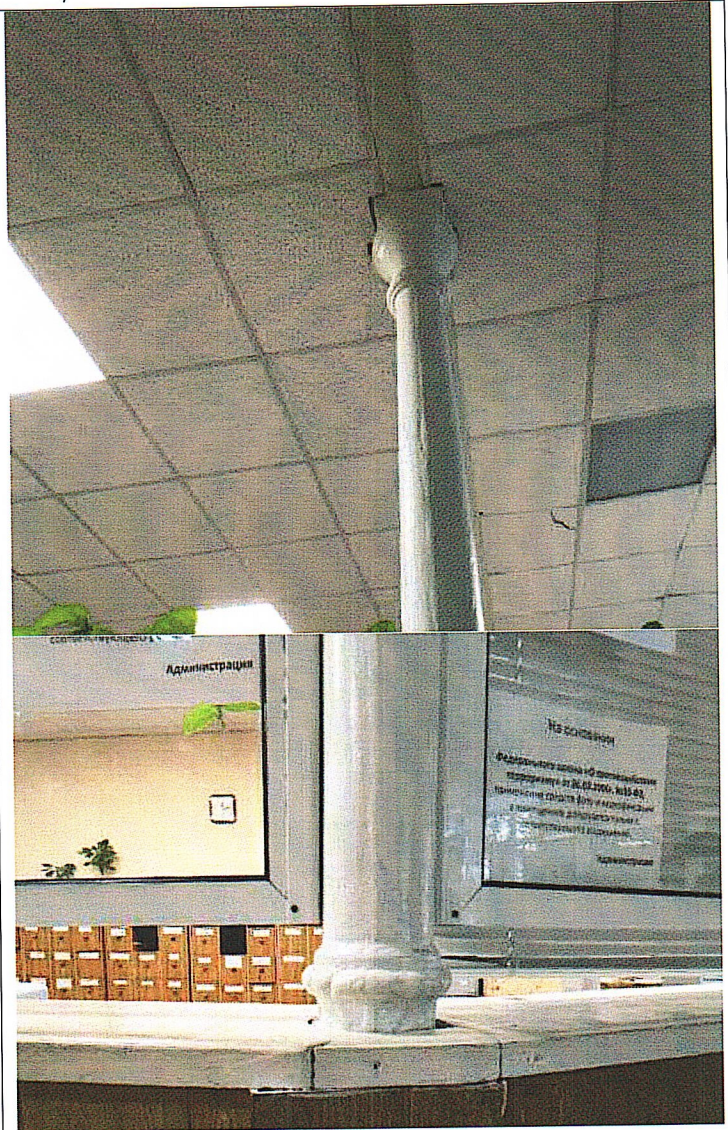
Историческая чугунная колонна в помещении на первом этаже
